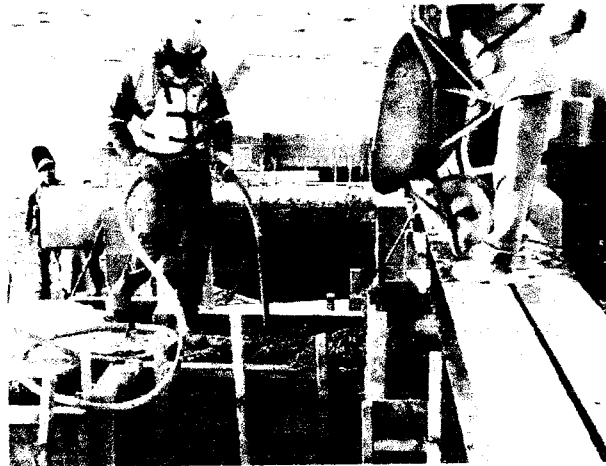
Reparación de vigas cabezales en puente de acceso al muelle. Obras de mar
